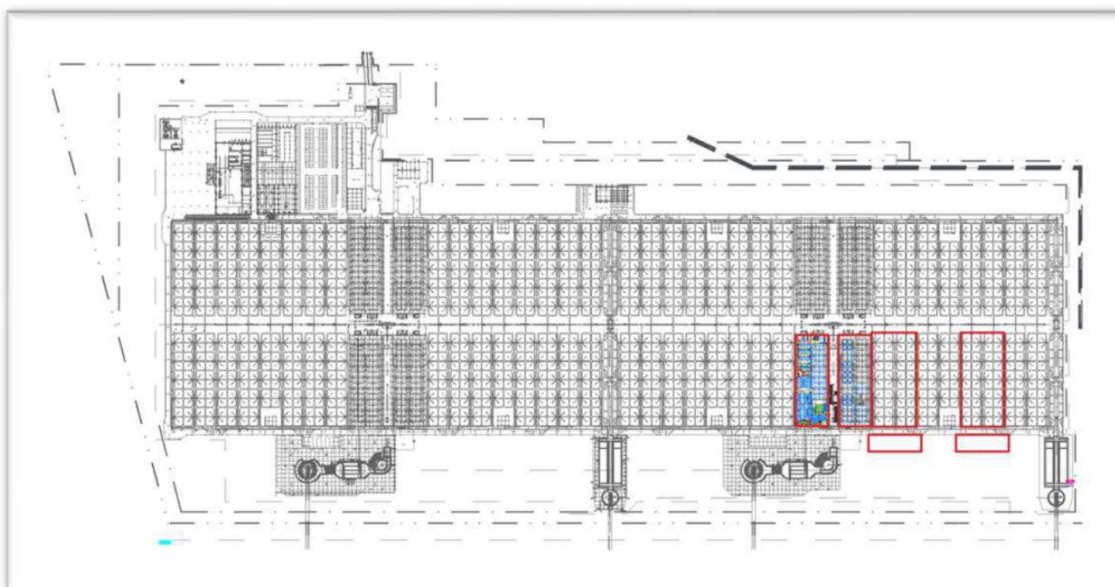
Planta Geral da Flatlantic - Zona de intervenção delimitada a vermelho
